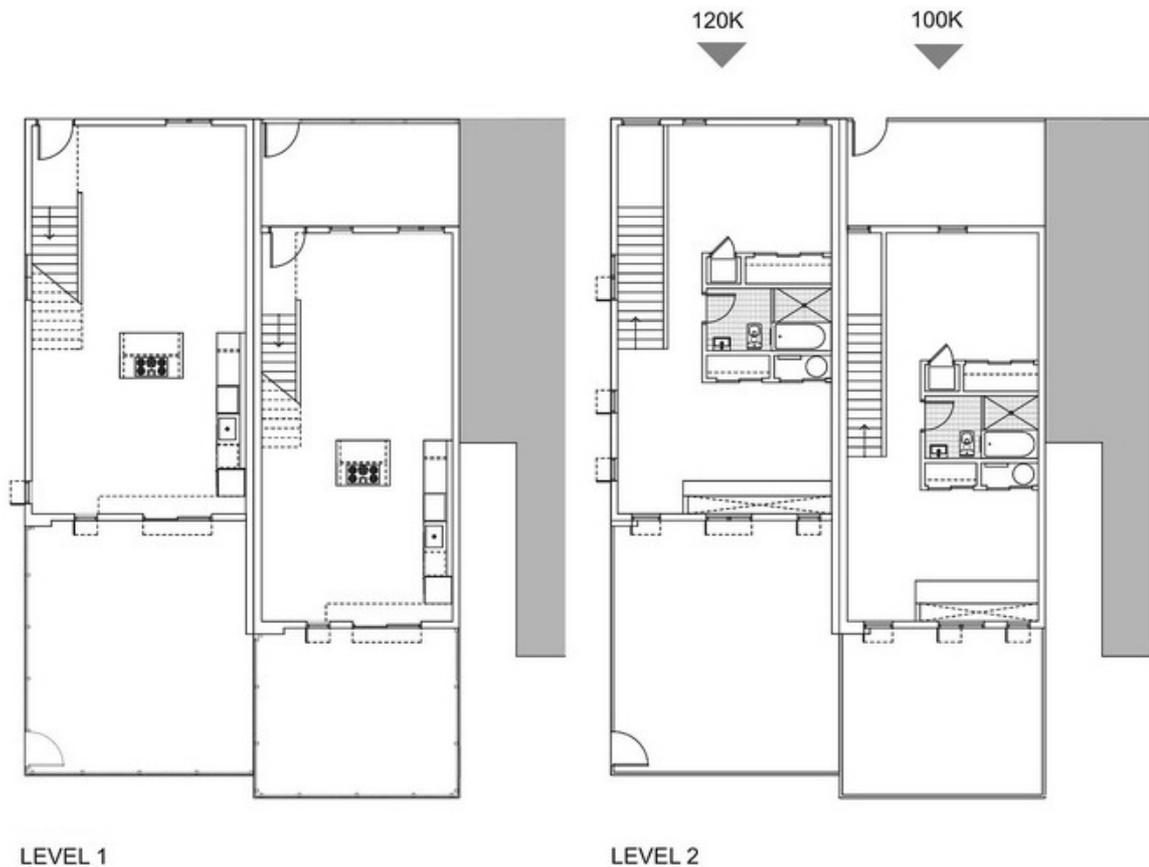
Plantas do pavimento superior e inferior das casas 100K e 120K
